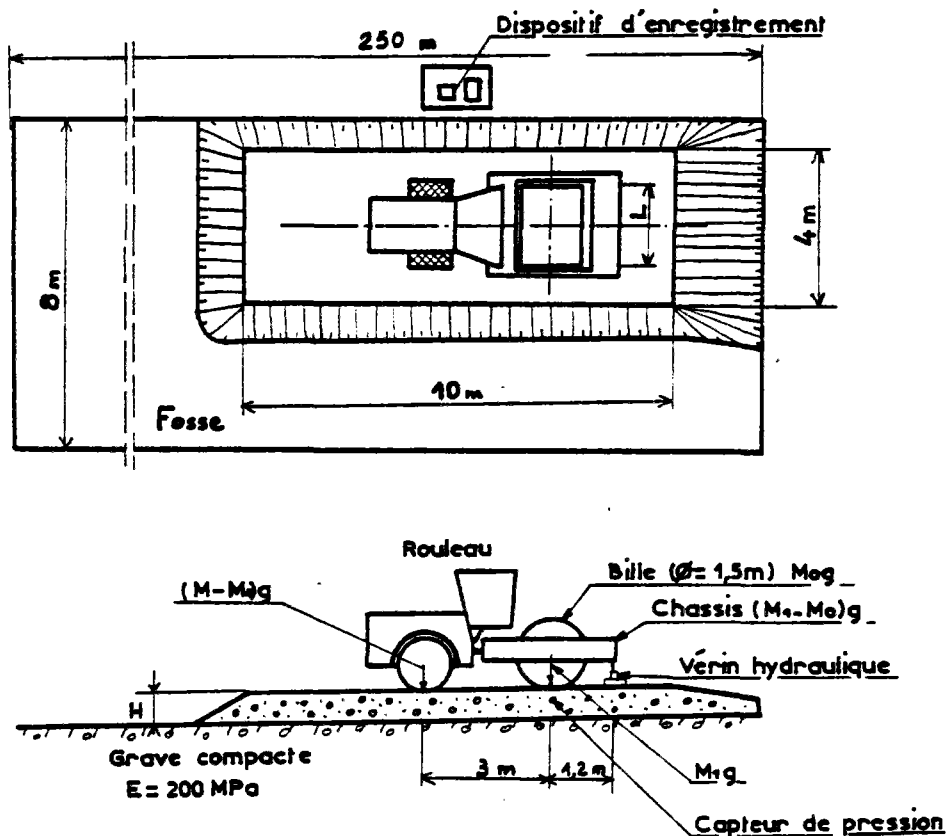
Vue en plan et coupe verticale des planches expérimentales.
